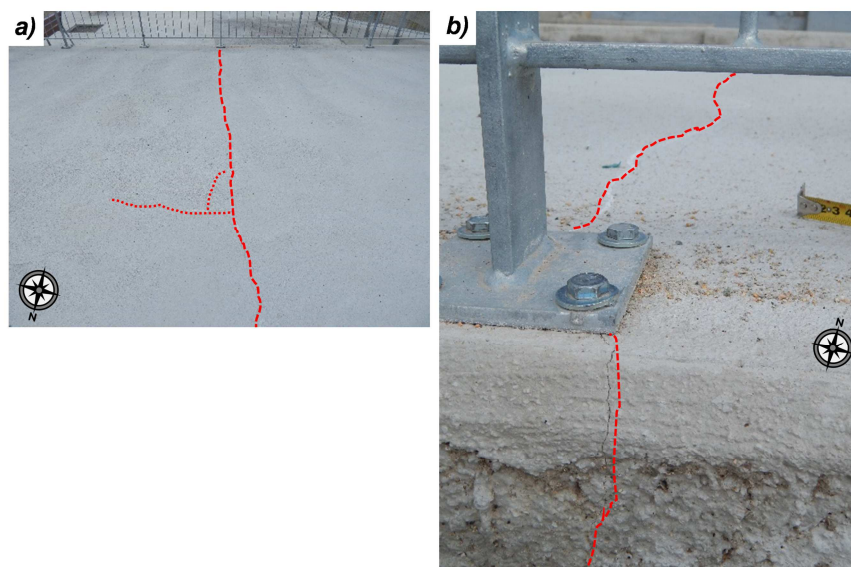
73 – Fisura longitudinal y transversal en losa Norte (parte superior)
